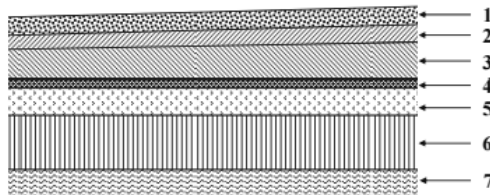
Eléments constituant le « plancher-terrasse ».
